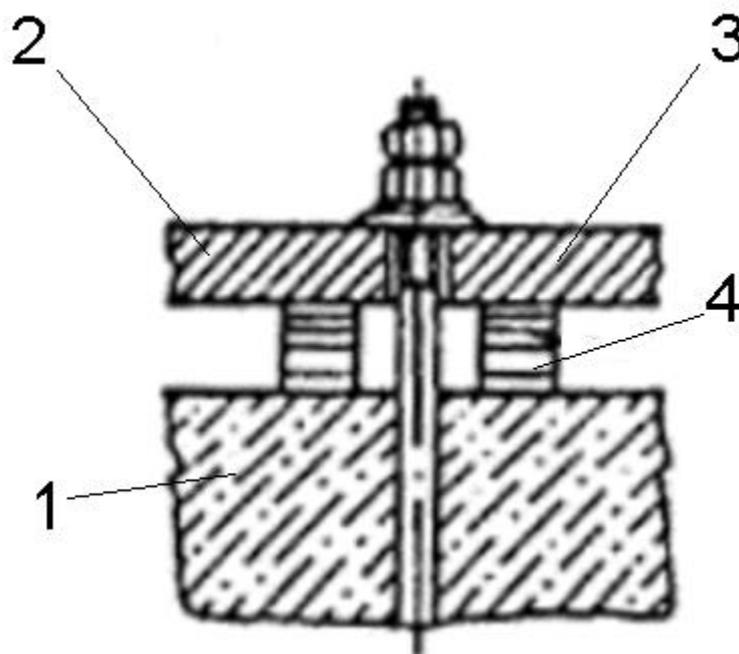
Выверка с помощью подкладок: 1 - фундамент, 2 - анкерный болт, 3 - монтируемое оборудование, 4- подкладки.
